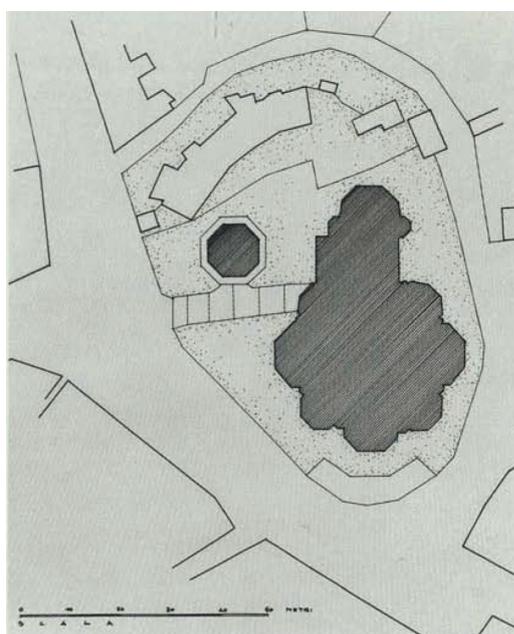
P. Zanini, Schema planimetrico del Duomo di Mortegliano con il progetto del nuovo campanile. Archivio Zanini, Civici Musei, Udine.
